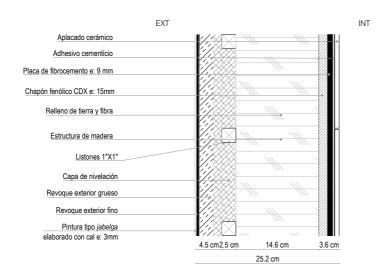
M1 ro1. Muro exterior - interior baño. esc.1:10. Fuente: Elaboración propia.
